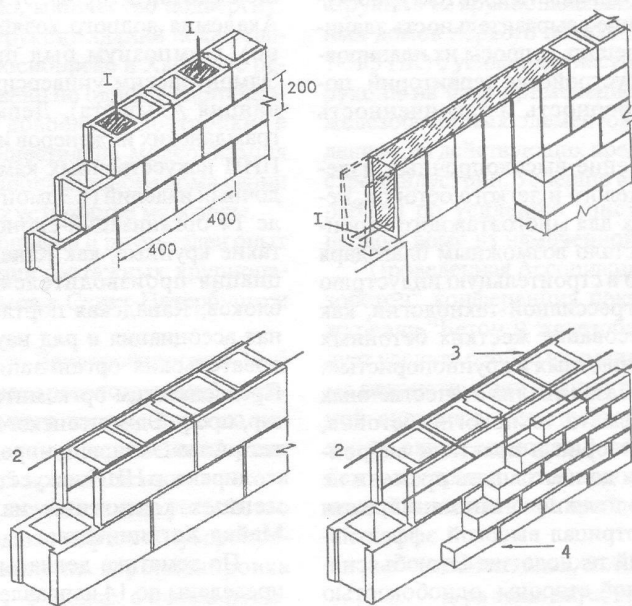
Конструктивные решения стен и перемычек из бетонных блоков
